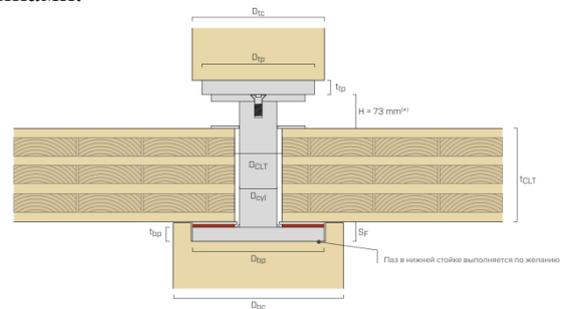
PILLAR система соединения «колонна-перекрытие»
